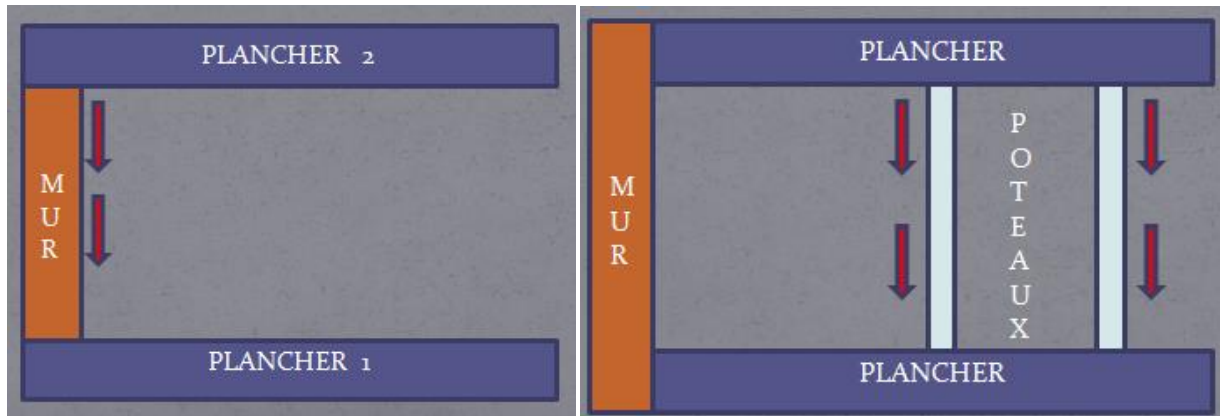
Exemple de mur porteur (figure de gauche)
